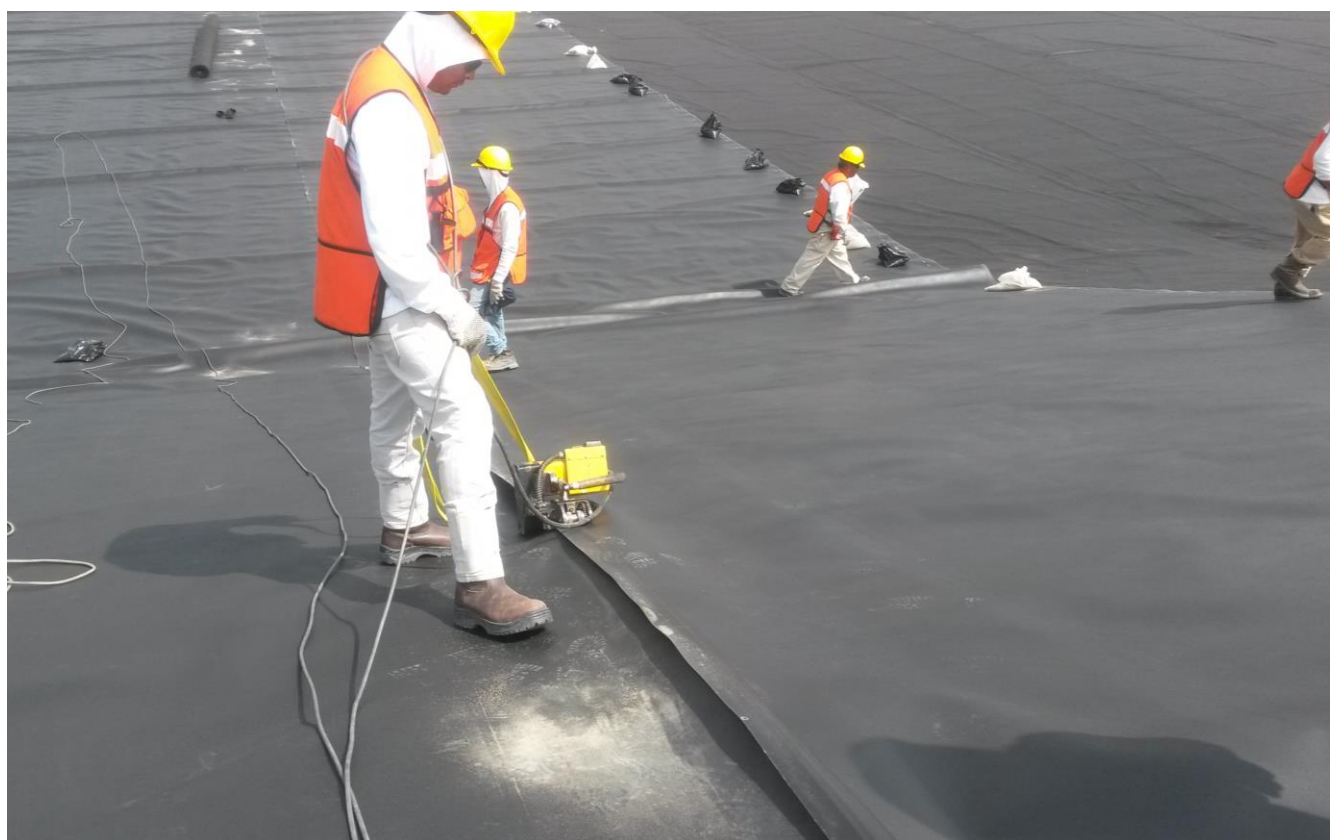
Soldadura de doble cuña por termofusión de la cobertura impermeable de geomembrana.
